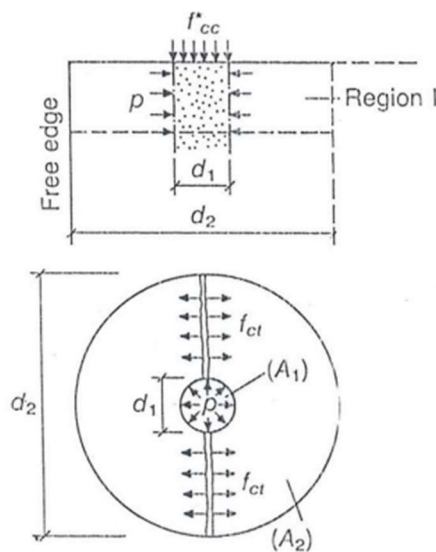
Expansão transversal do betão na região superior perto de uma face final parcialmente comprimida, incluindo fissuras transversais (Código-Modelo 90)
